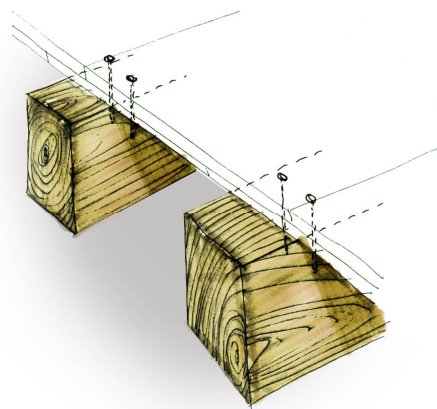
Reforço com recurso a elementos de betão armado: utilização de derivados de madeira que servirão de cofragem à lajeta de betão armado
